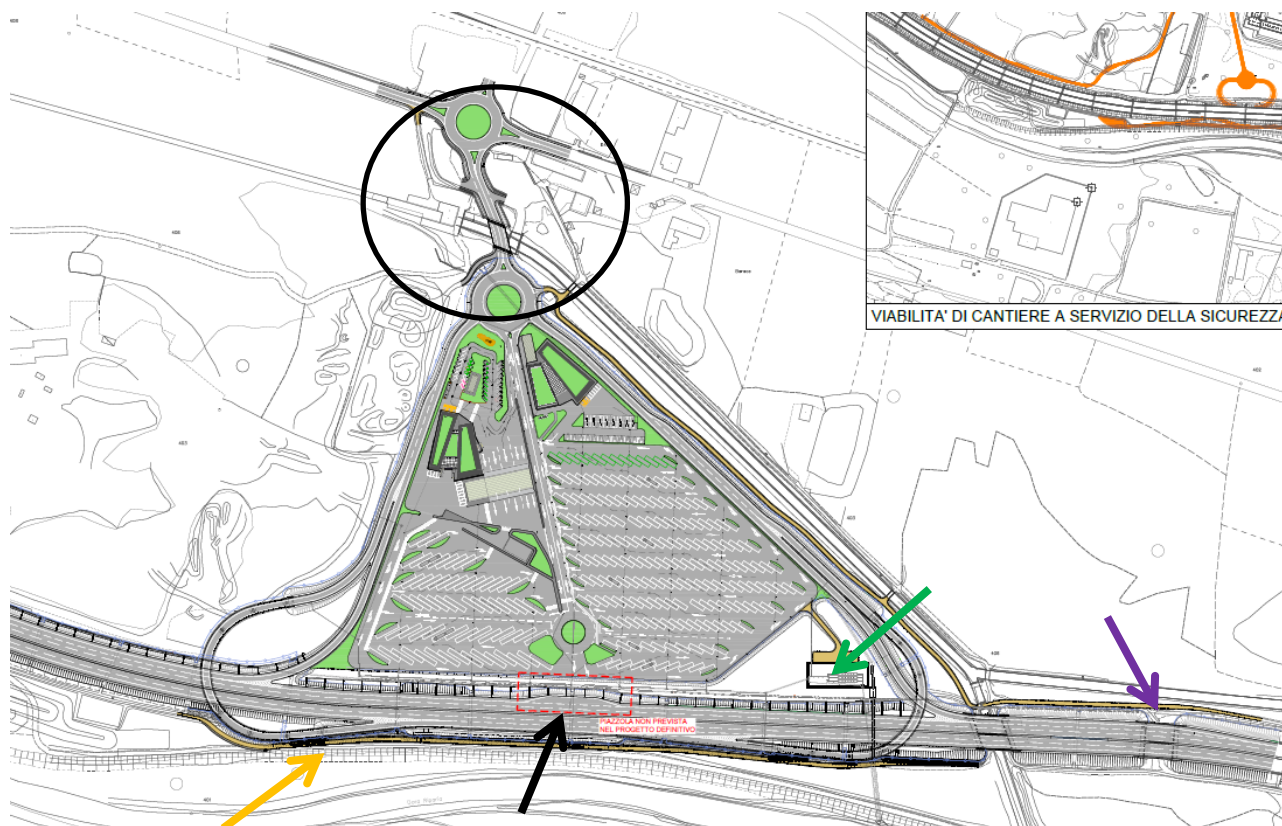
Planimetria stato finale in fase di esercizio- Progetto Esecutivo
